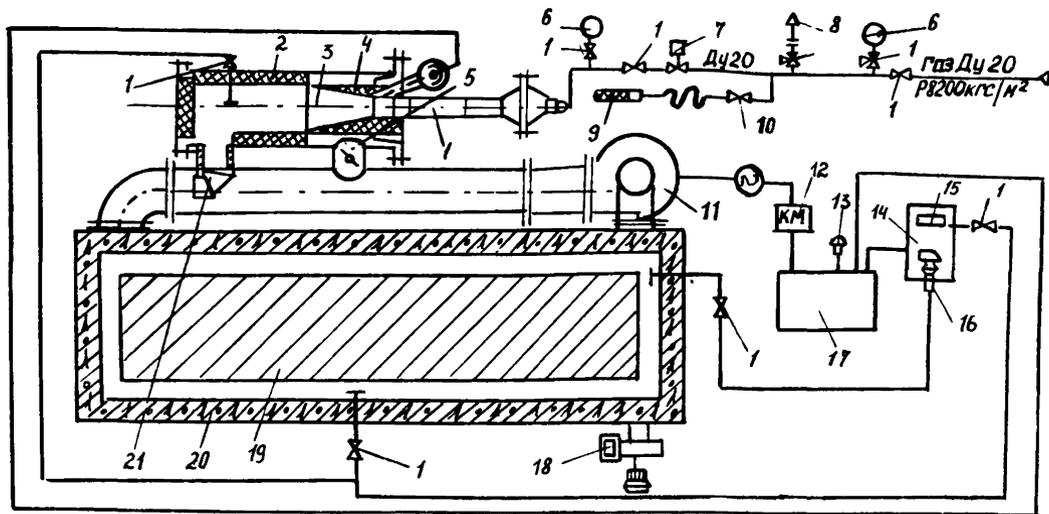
Принципиальная схема установки тепловой обработки железобетона:
